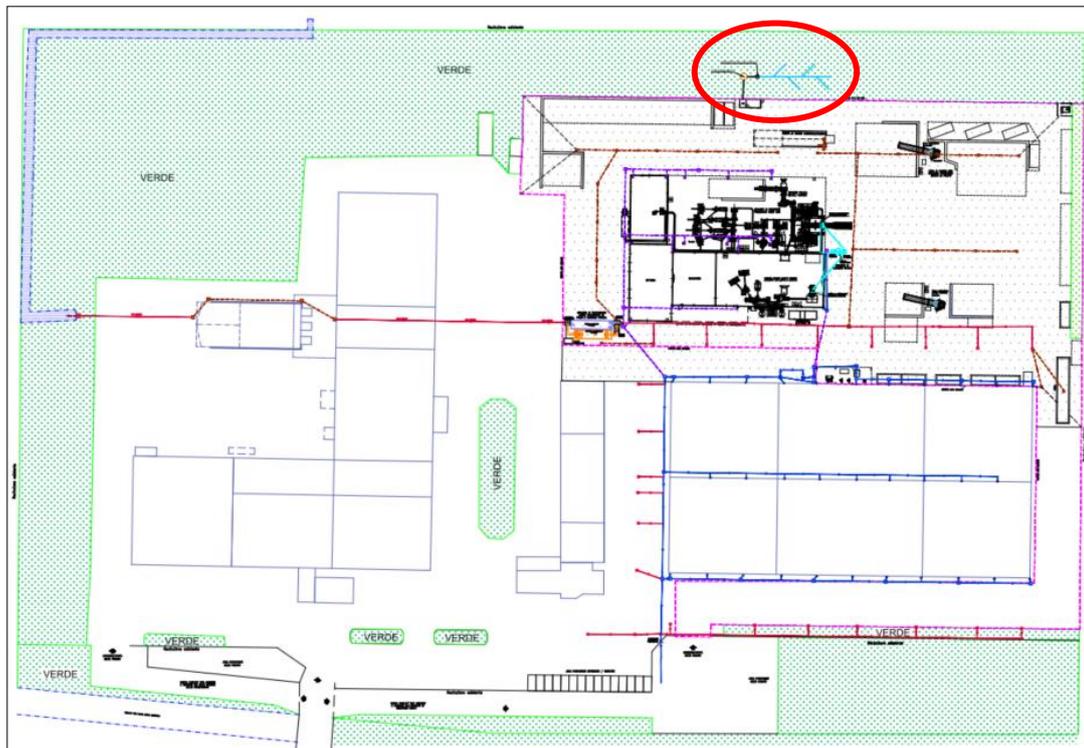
Planimetria dell'impianto industriale con ubicazione del sistema di dispersione
